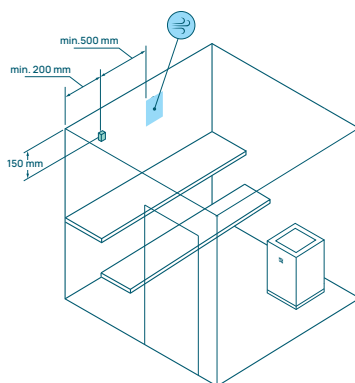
Posizione del sensore panca dall'angolo, dall'apertura e dal soffitto
